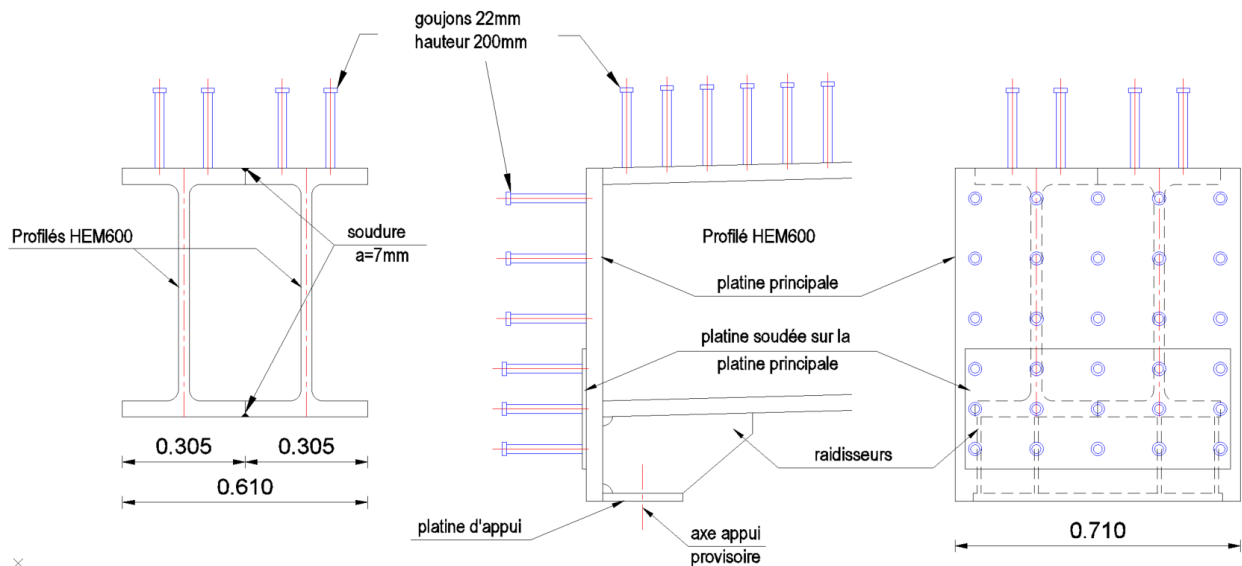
Connexion caisson/entretoise utilisée sur le pont du triangle à Dunkerque
